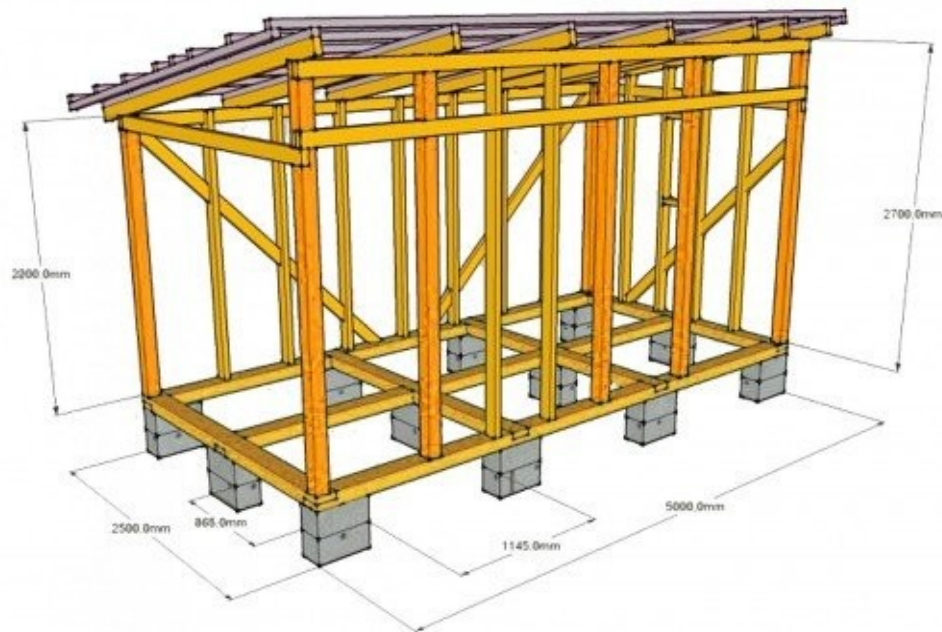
Чертёж склада для кормов и инвентаря
